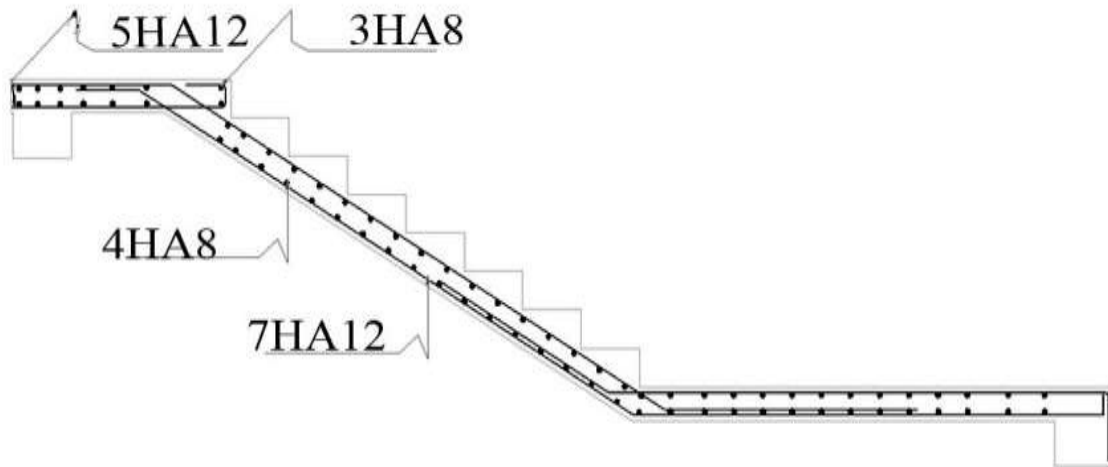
Schéma de ferrailage de l'escalier par ml.
